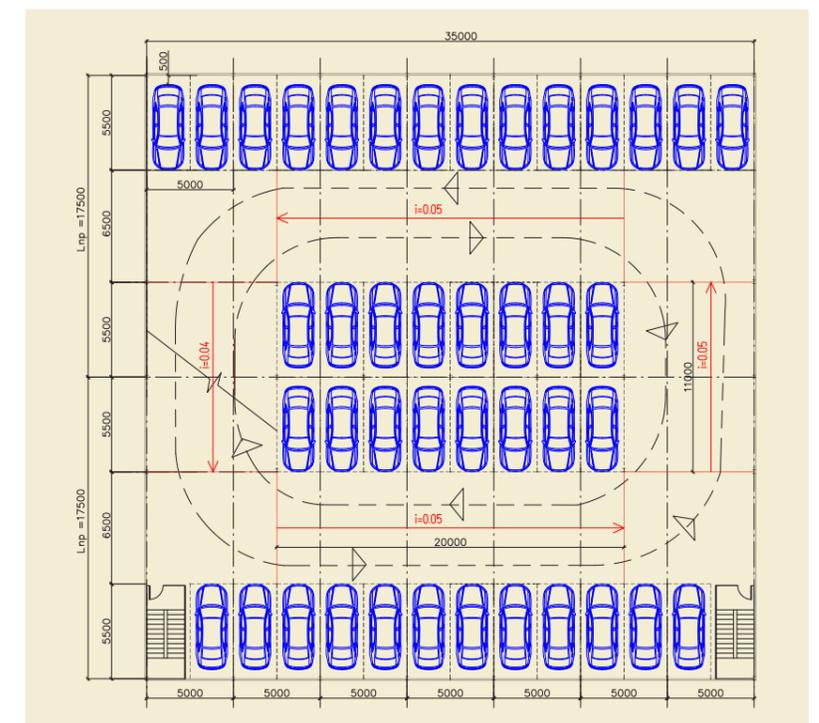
План типового этажа для НМРА с наклонными перекрытиями
